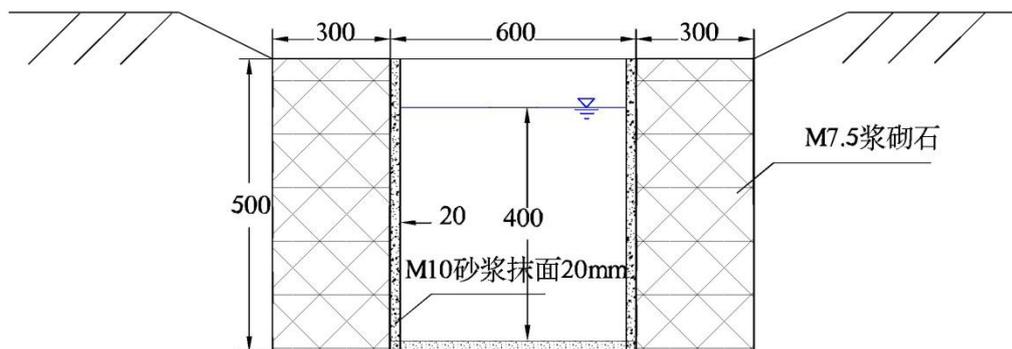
P1 截排水沟断面示意图 (单位 mm)
